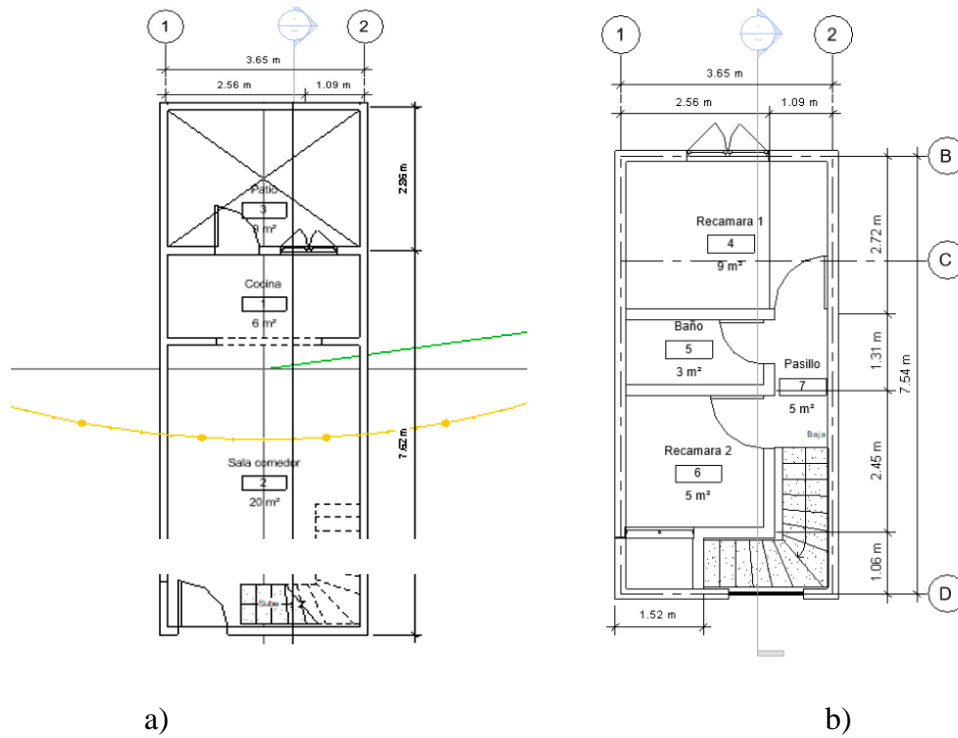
a) planta baja arquitectónica y b) planta alta arquitectónica
